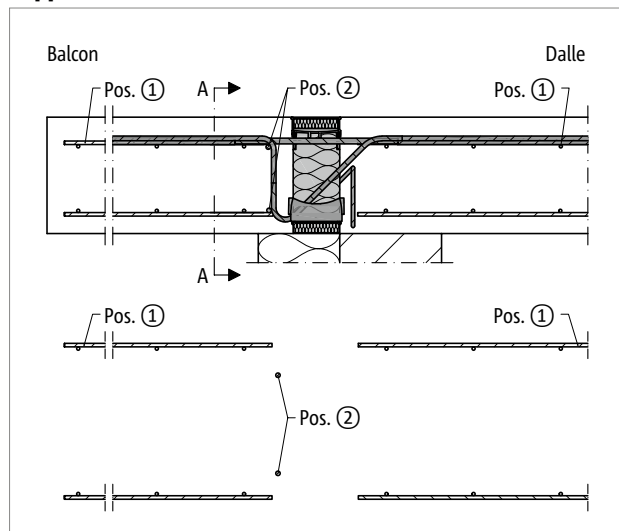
Schöck Isokorb® T Type K-E, K-T : Renforcement sur site ; bord de plancher avec supports muraux
